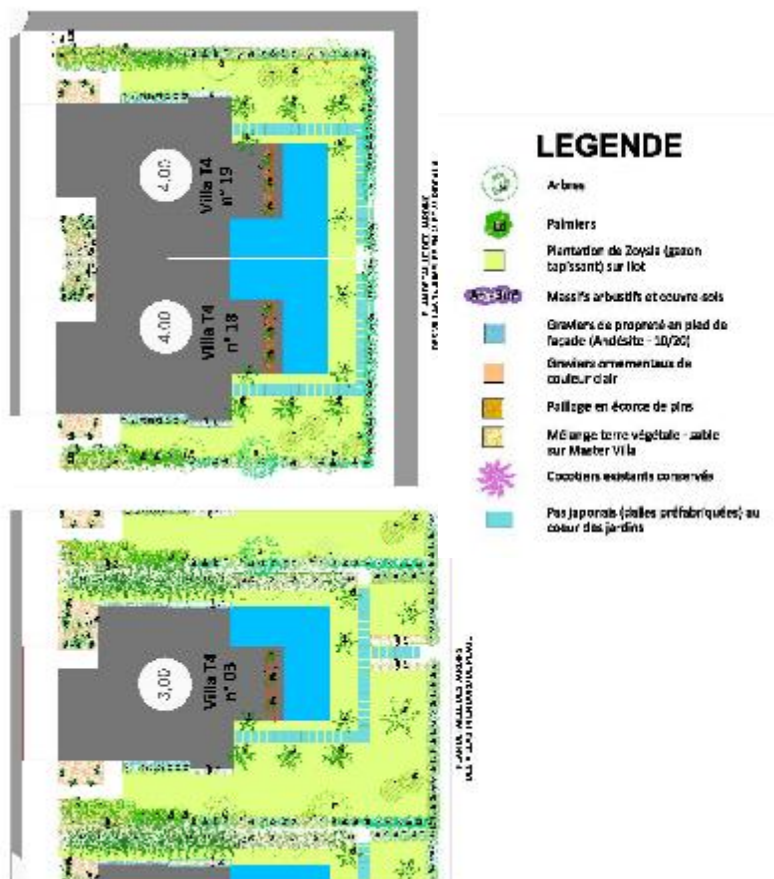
Plan détaillé du traitement paysager des jardins des villas (source : Caraïbes paysages)
